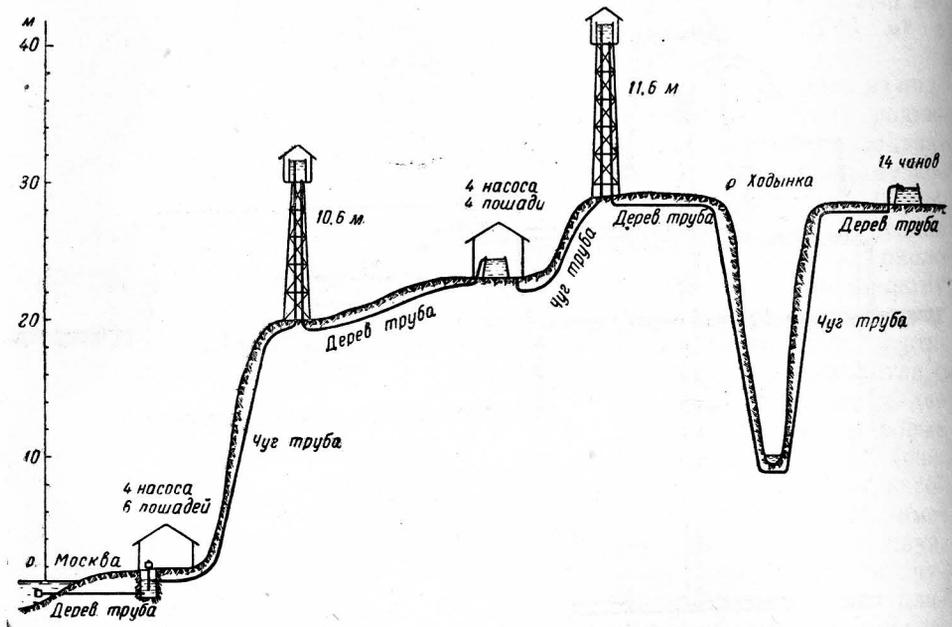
Схема водопровода Ходынского лагеря (реконструкция).
